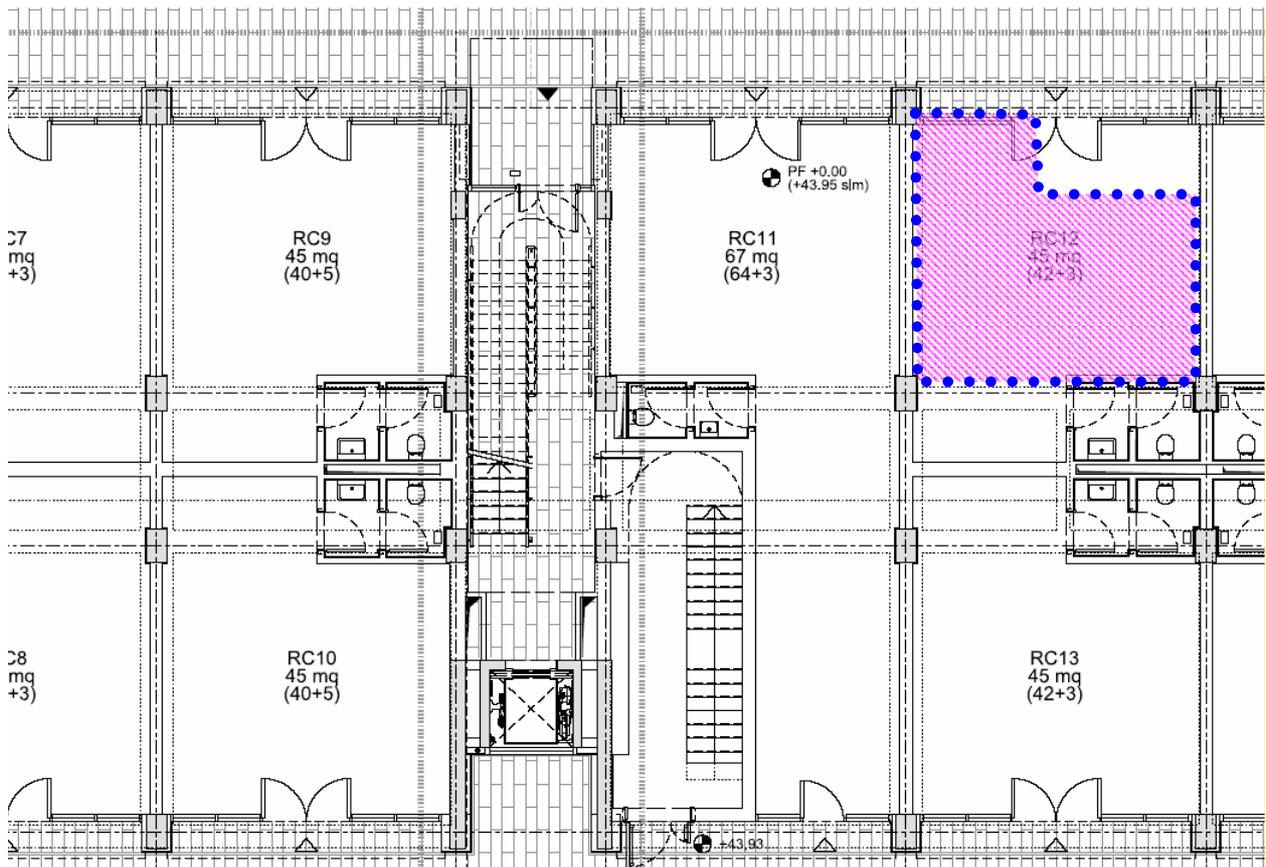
Proiezione della porzione di solaio oggetto di verifica sul piano terra
